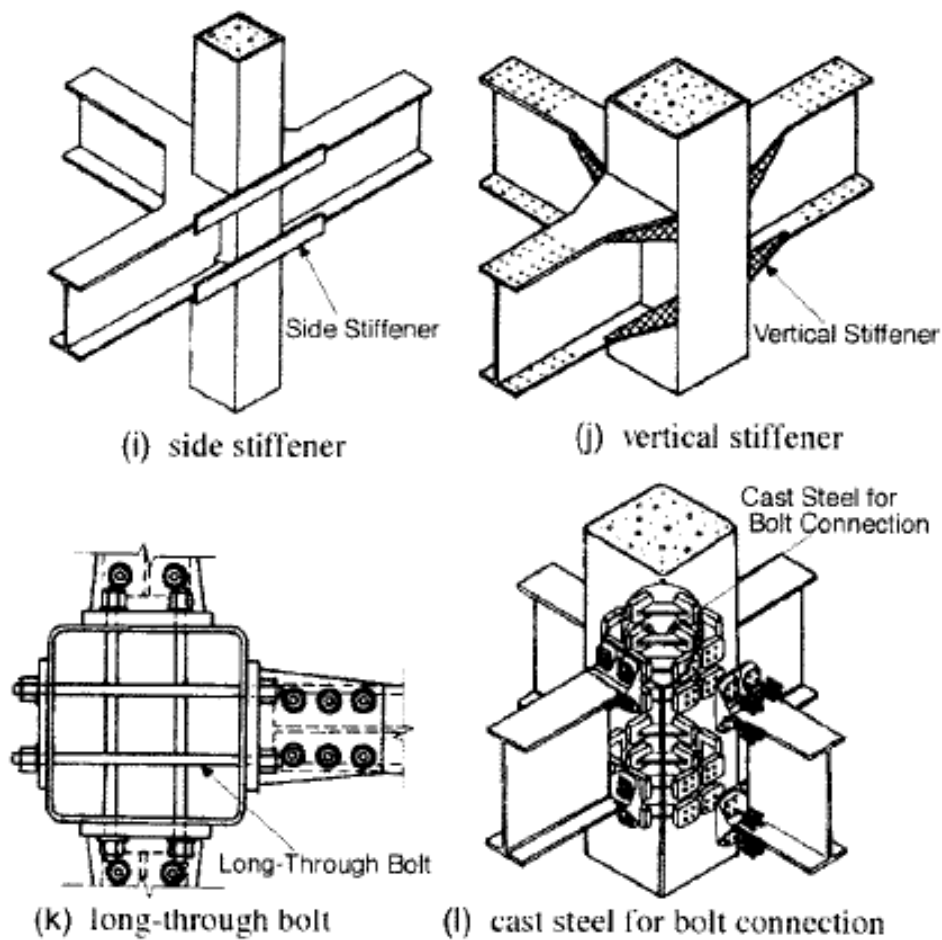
Detalles recientemente desarrollados de conexión de acero viga-columna cuadrada. [18]
